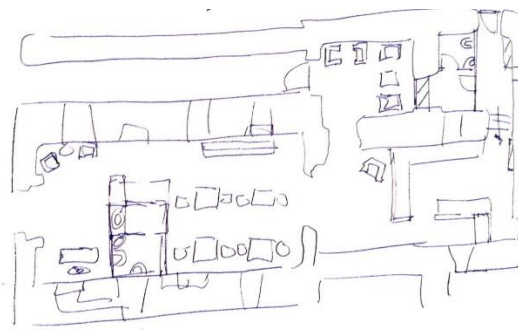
Planta de estudo; Fonte: Mariana Vieira.
